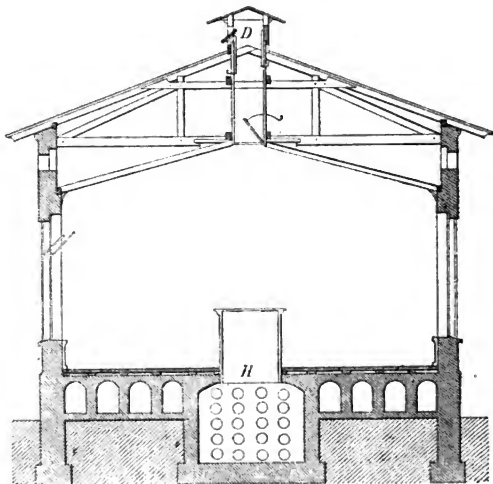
Einstöckiger Krankenpavillon mit Dachfirstventilation.
